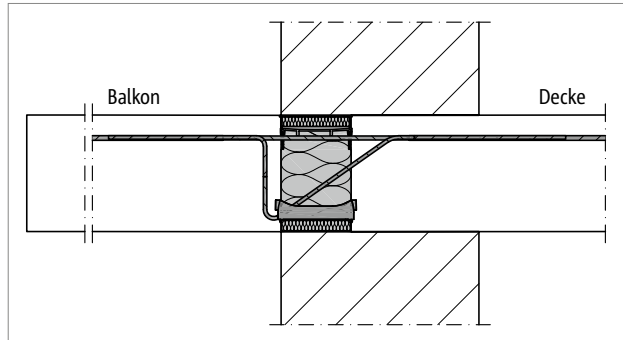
Schöck Isokorb® XT Typ K: Anschluss bei einschaligem Mauerwerk
